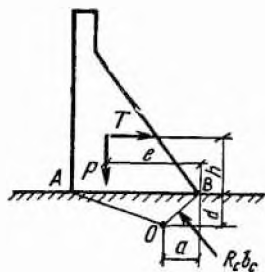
К расчету по схеме предельного поворота ($b_c = OB$ — площадь сжатия)
